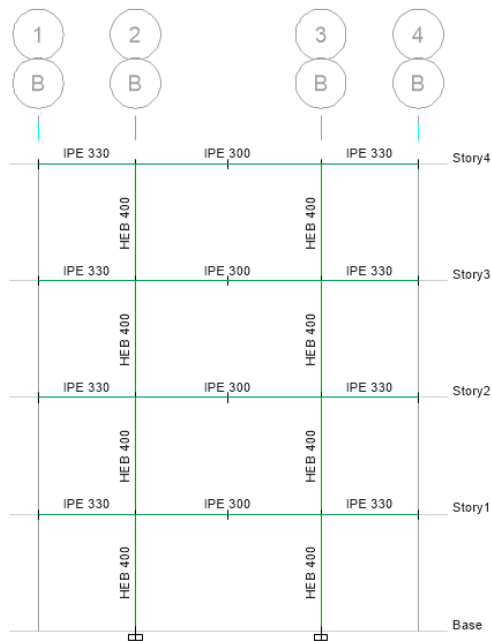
Vista en elevación de elementos en voladizo para estructura metálica.
